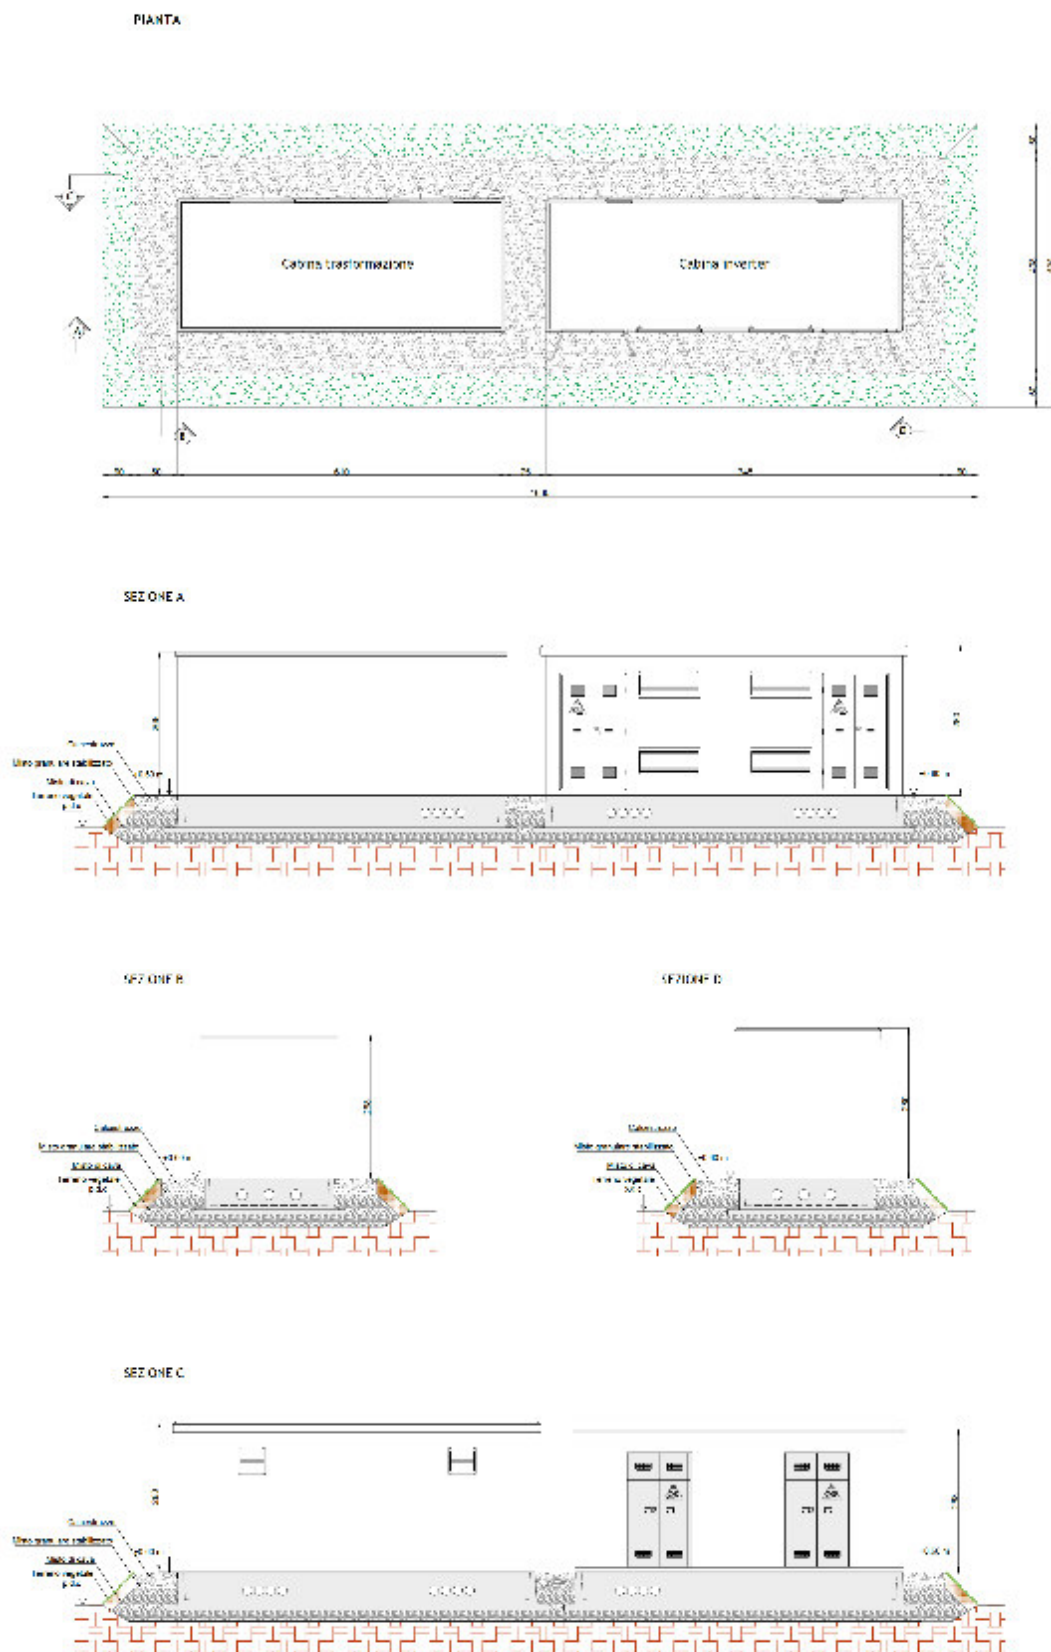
Planimetria e prospetto della Cabina di Trasformazione e Cabina inverter
